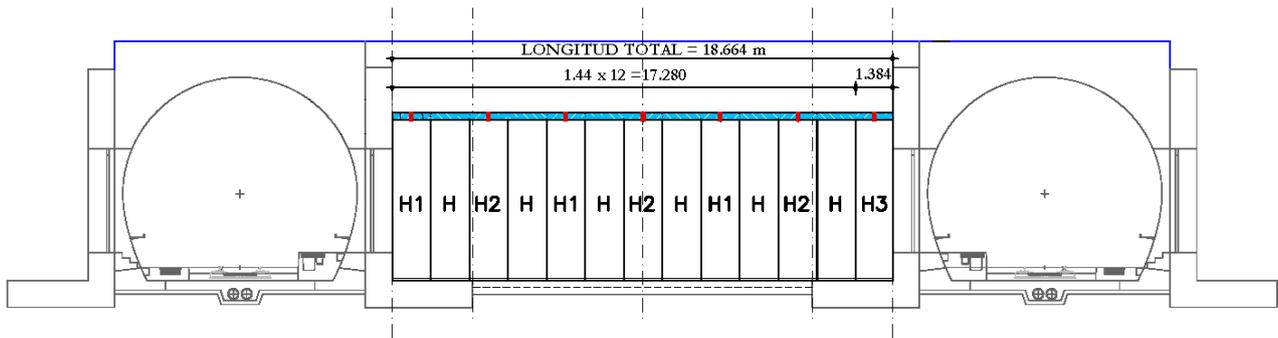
Alzado de las piezas prefabricadas de encofrado perdido y revestimiento en la GAI del túnel de la Canda
